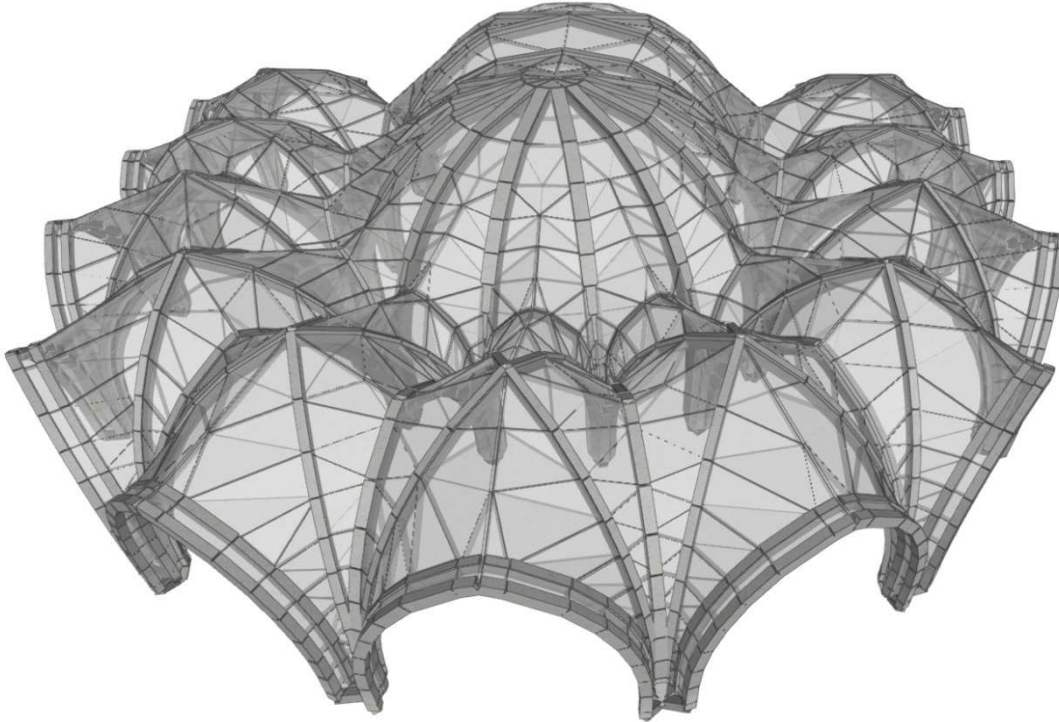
, detalles de las armaduras de las bóvedas de las naves laterales. Informe 18437-I del IETcc.
